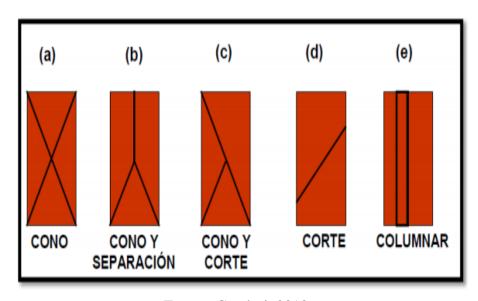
Tipo de roturas de probetas para ensayos de compresión.
